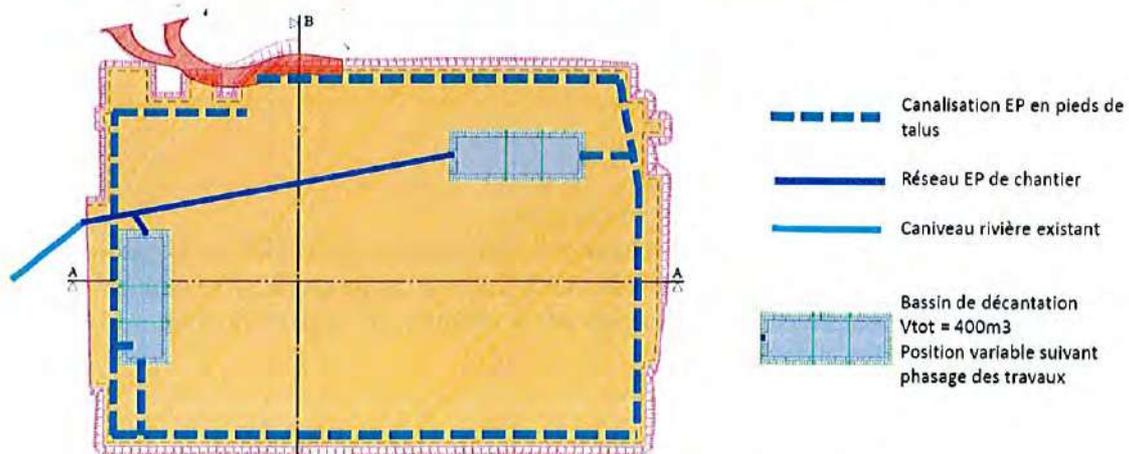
Plan masse des ouvrages de gestion des eaux pluviales pendant le terrassement
